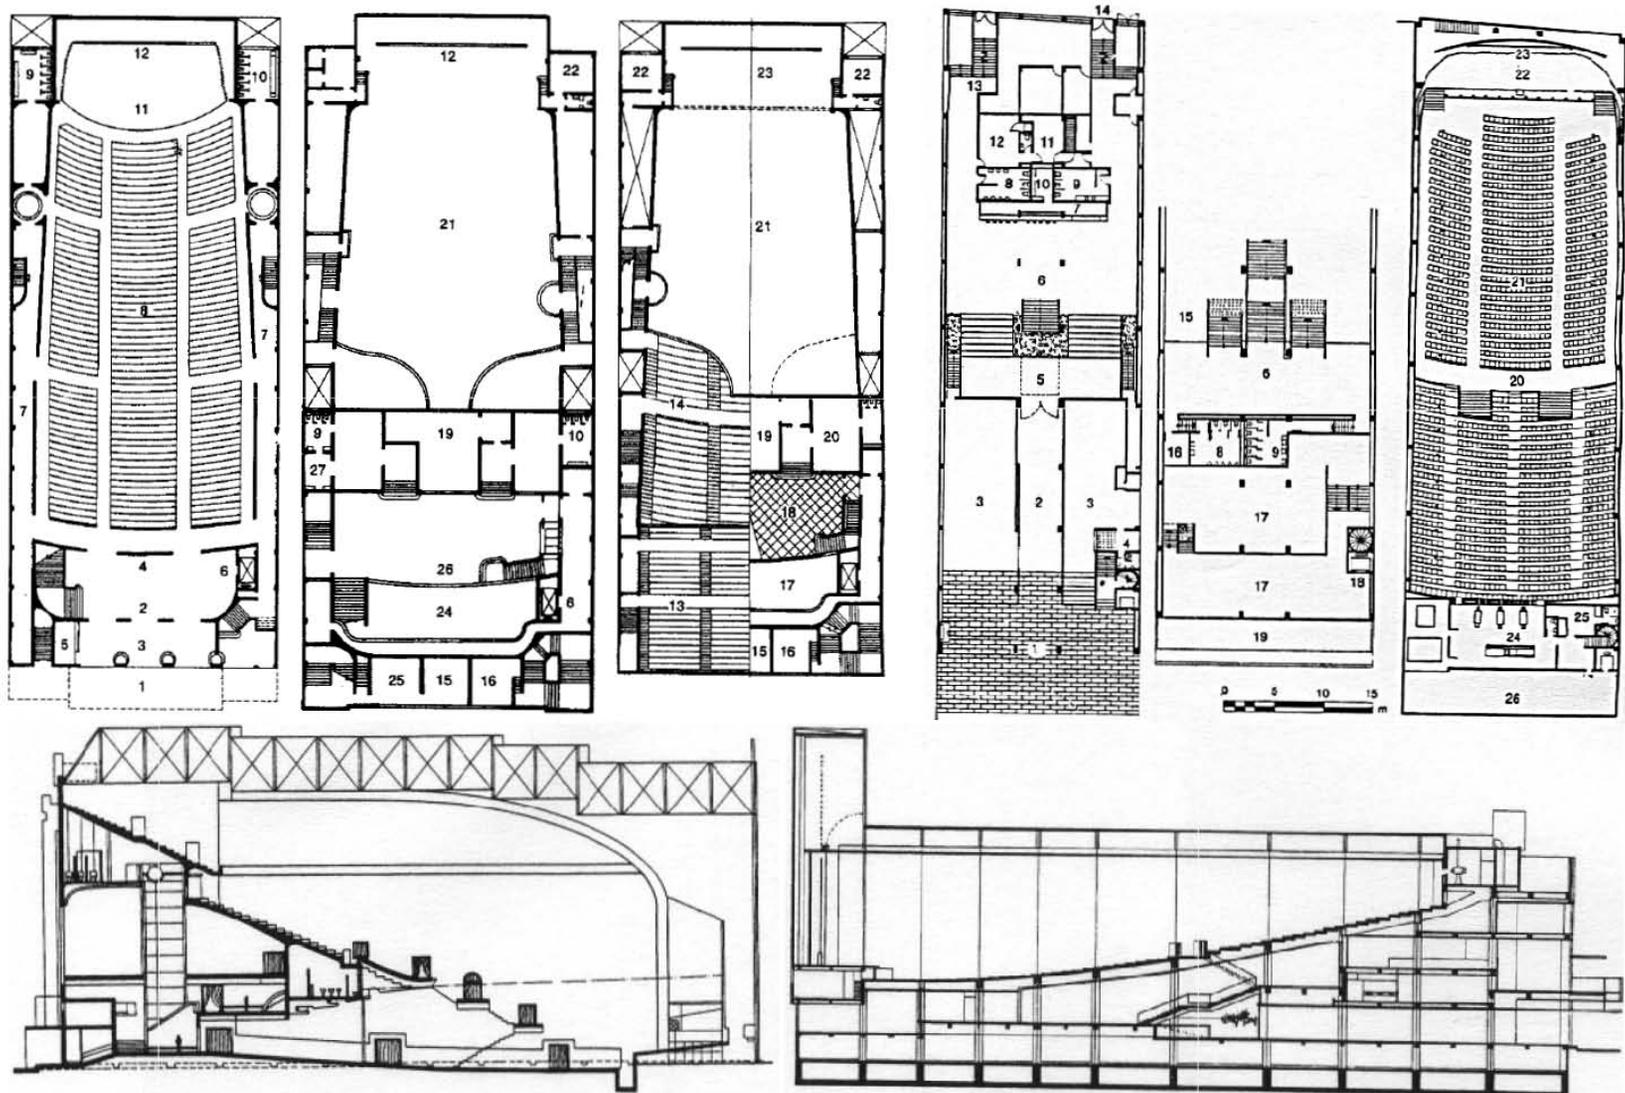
(Izq.). Planta baja, mezzanine, planta alta y corte longitudinal del Cine Encanto, diseñado por José Francisco Serrano en 1937.
